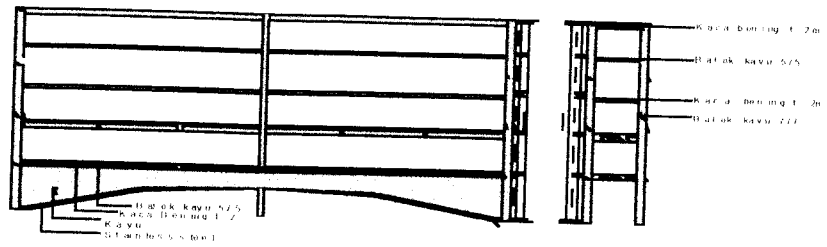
Layout Ruang Galeri Penjualan dan Pameran
